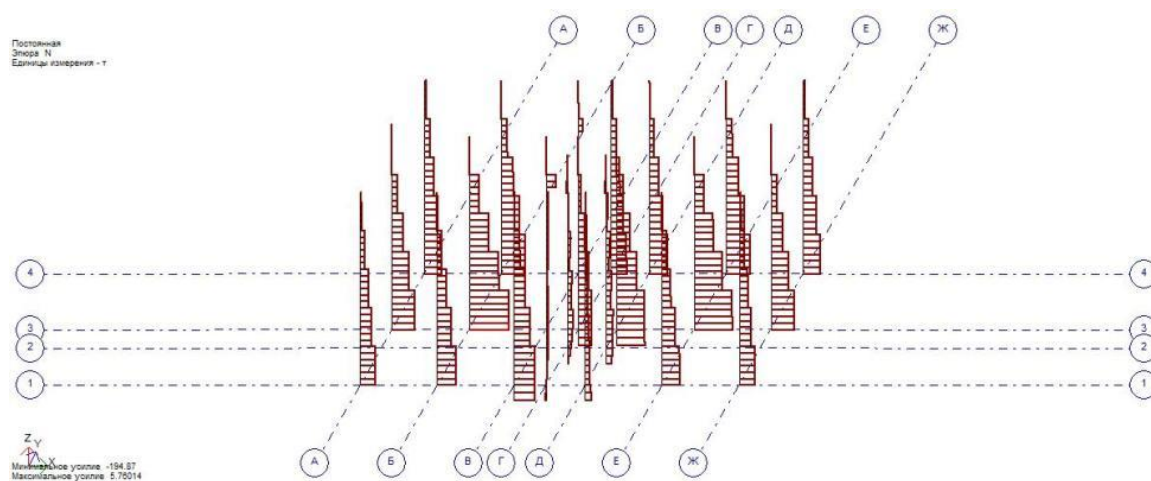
Усилия в колоннах здания (параметры фундаментов определены с учетом требований EN)
